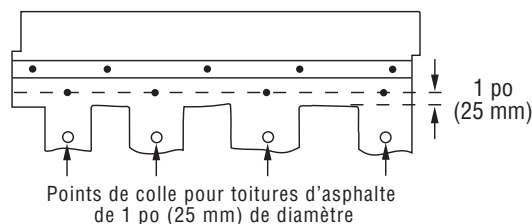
Fixation des bardeaux Presidential et Presidential TL sur les pentes raides.
